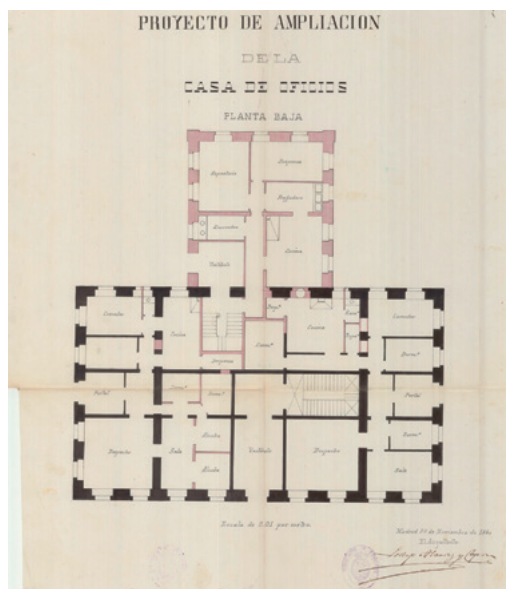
Proyecto de ampliación de la Casa de Oficios. Planta baja. Lorenzo Álvarez y Capra, 1880. Fuente: AGA, Fondo Ministerio de Educación, IDD (05)001.025, Caja 31/08133.
